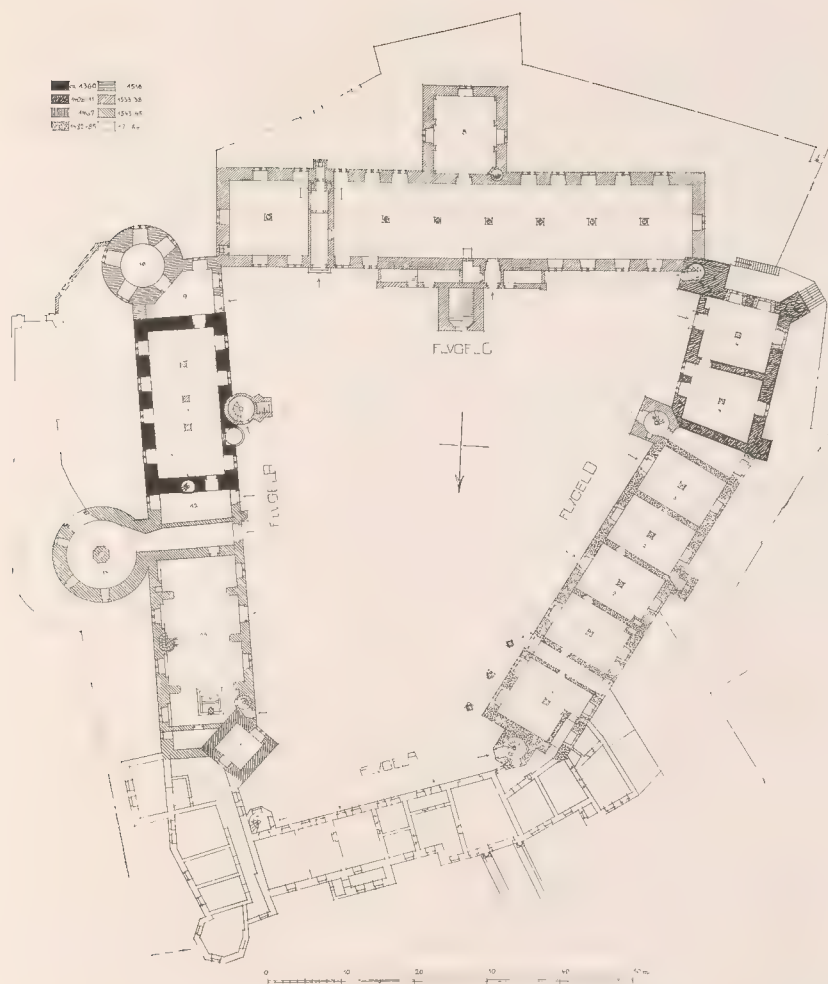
Rekonstruierter Grundriß des Erdgeschosses.
